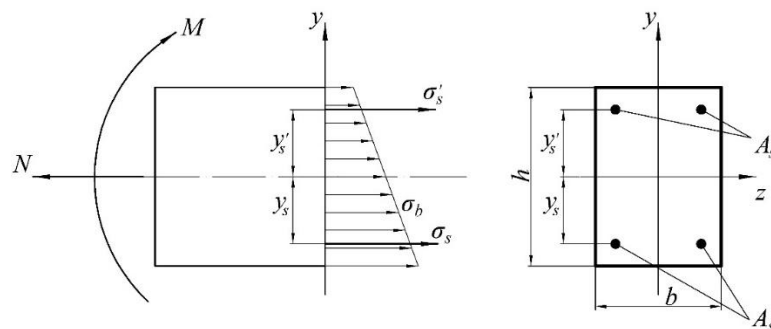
Расчетную схема и поперечное сечение железобетонного элемента
